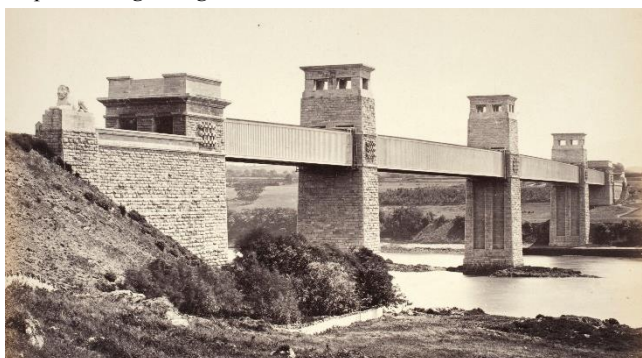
Il Britannia Bridge in una foto della seconda metà dell'Ottocento.
